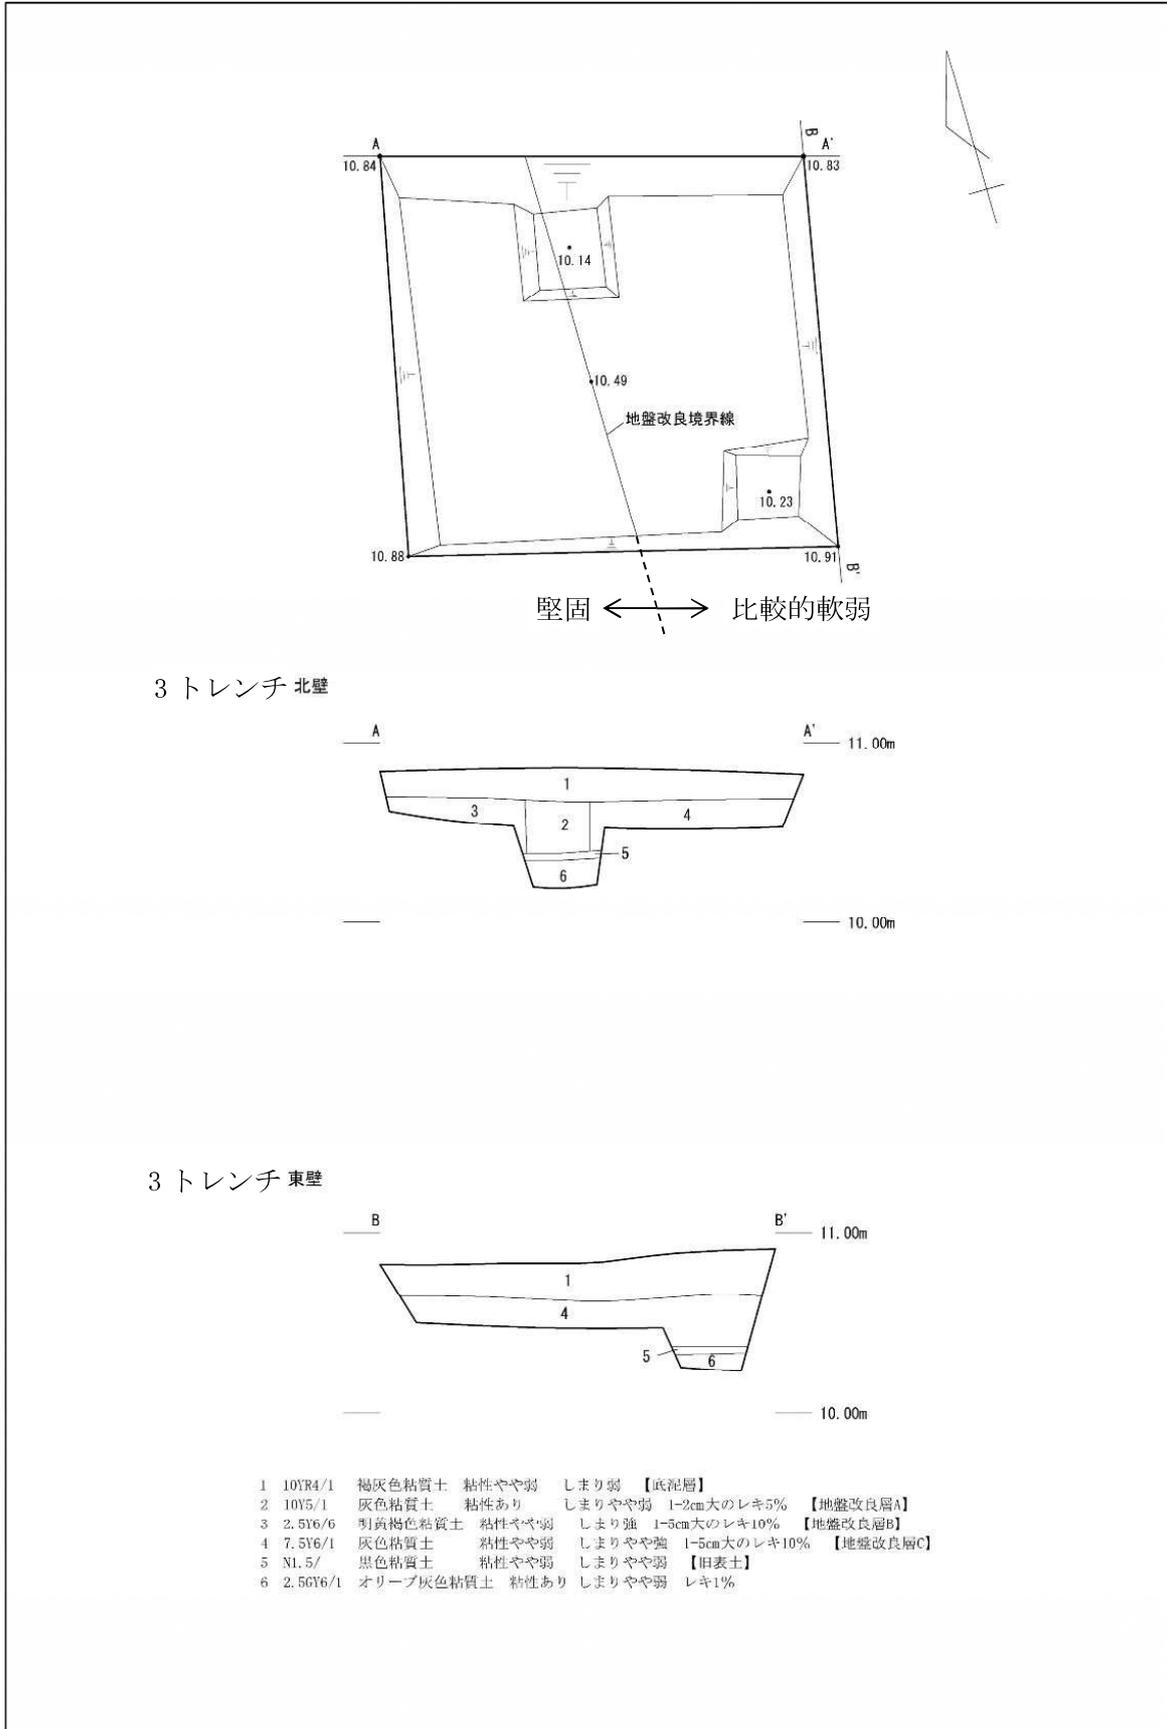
堀の現況調査 3 トレンチ平面図・断面図 (縮尺 1/40)
